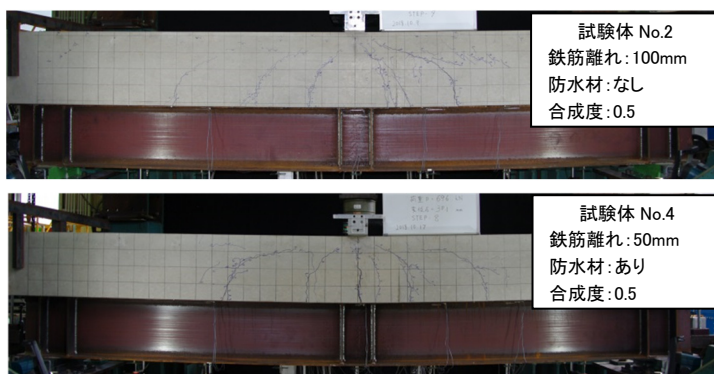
最大耐力到達時の破壊(試験体 No.2, No.4)
